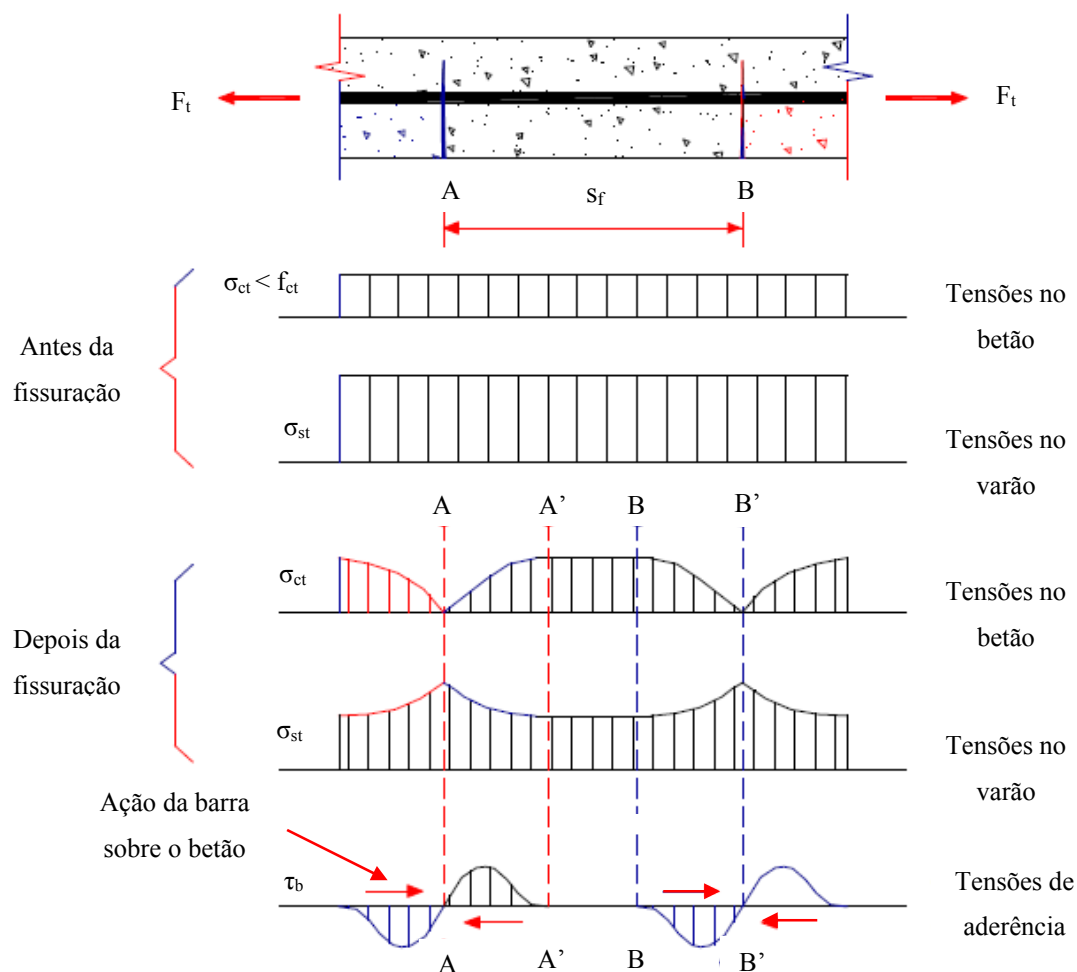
Fissuração por tração (sem escala) - Leonhardt, F. e Monnig, E [30]
